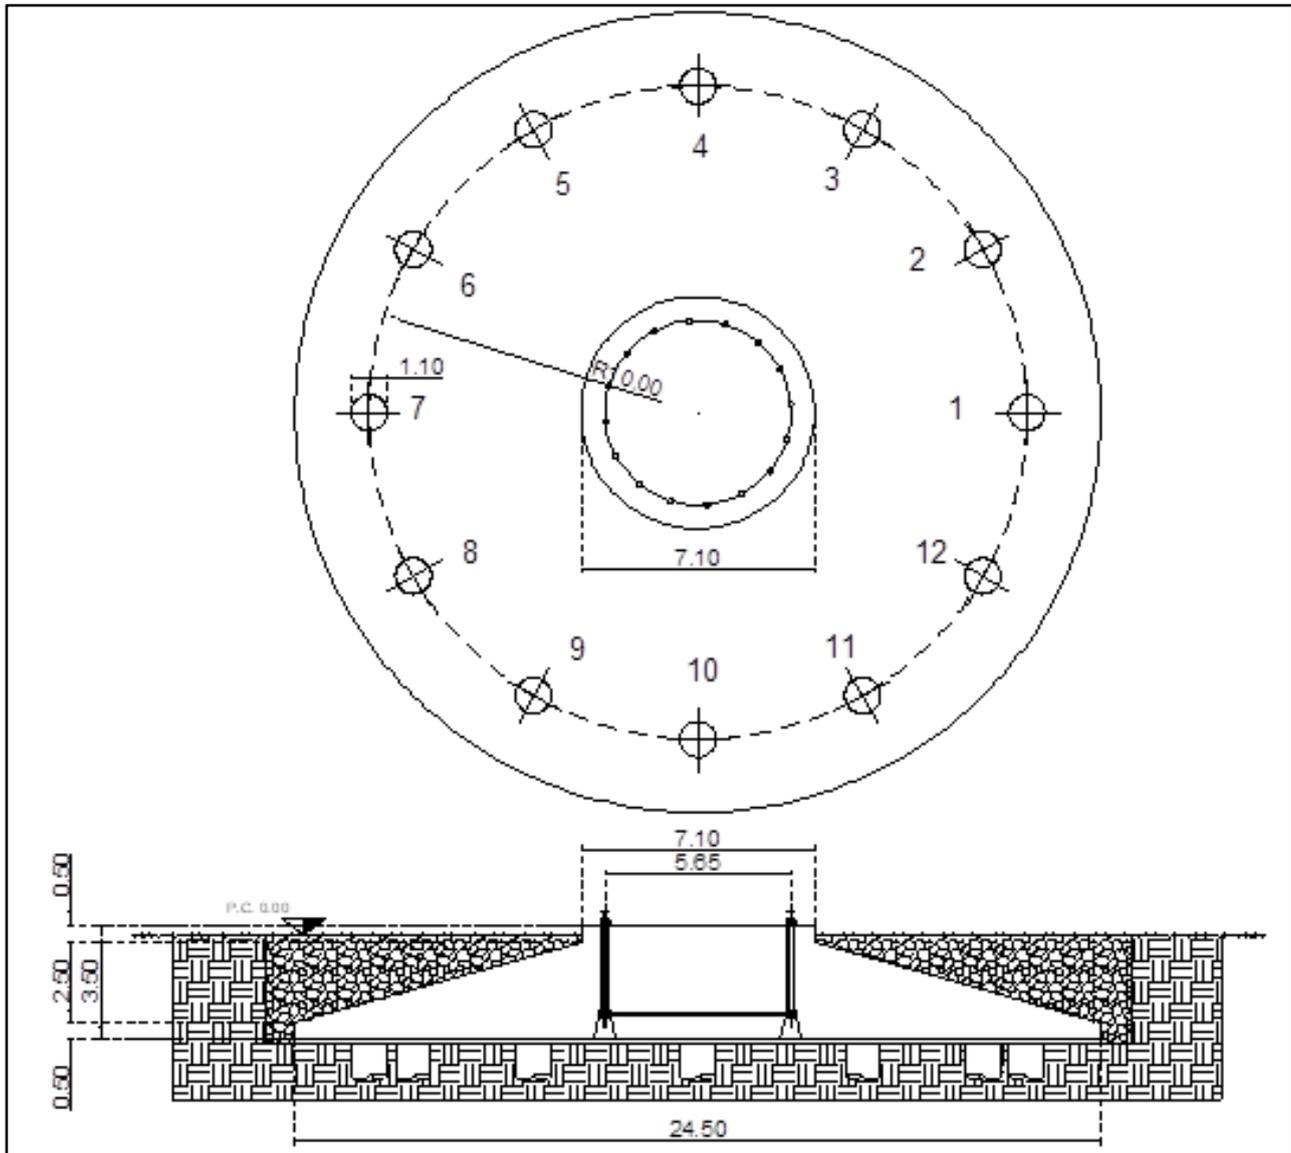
Dettaglio pianta e sezione fondazione
